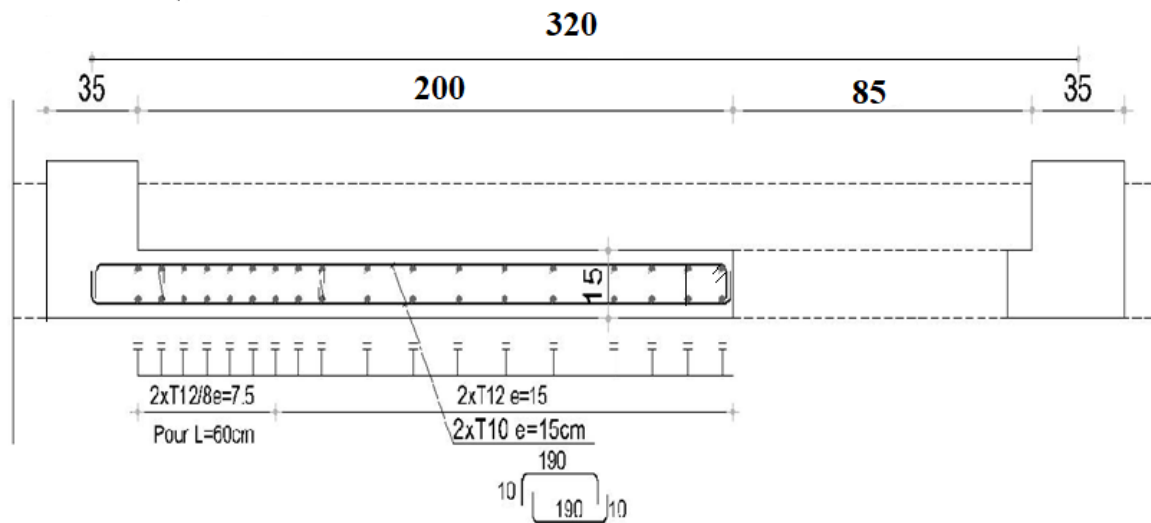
Dessin du ferrailage du voile de contreventement.
